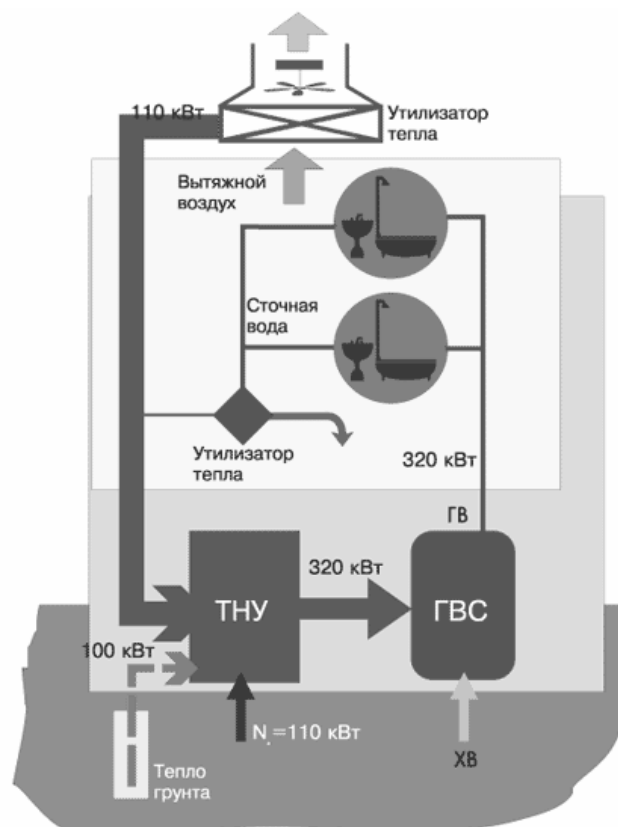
Схема теплоснабжения системы горячего водоснабжения за счет утилизации тепла вытяжного воздуха и тепла грунта
